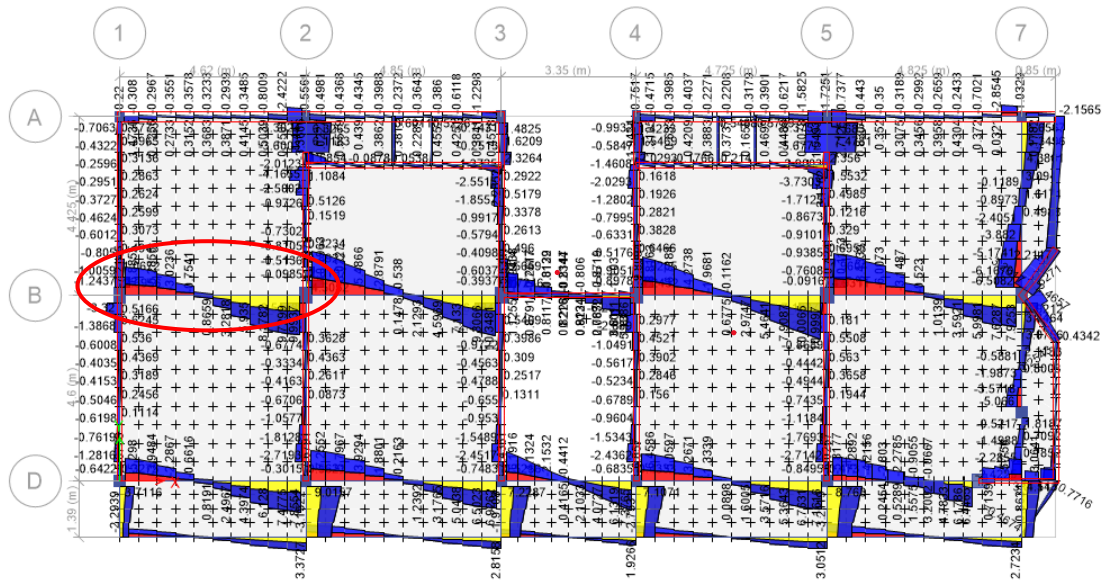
Esfuerzo cortante vista en planta del cuarto nivel
